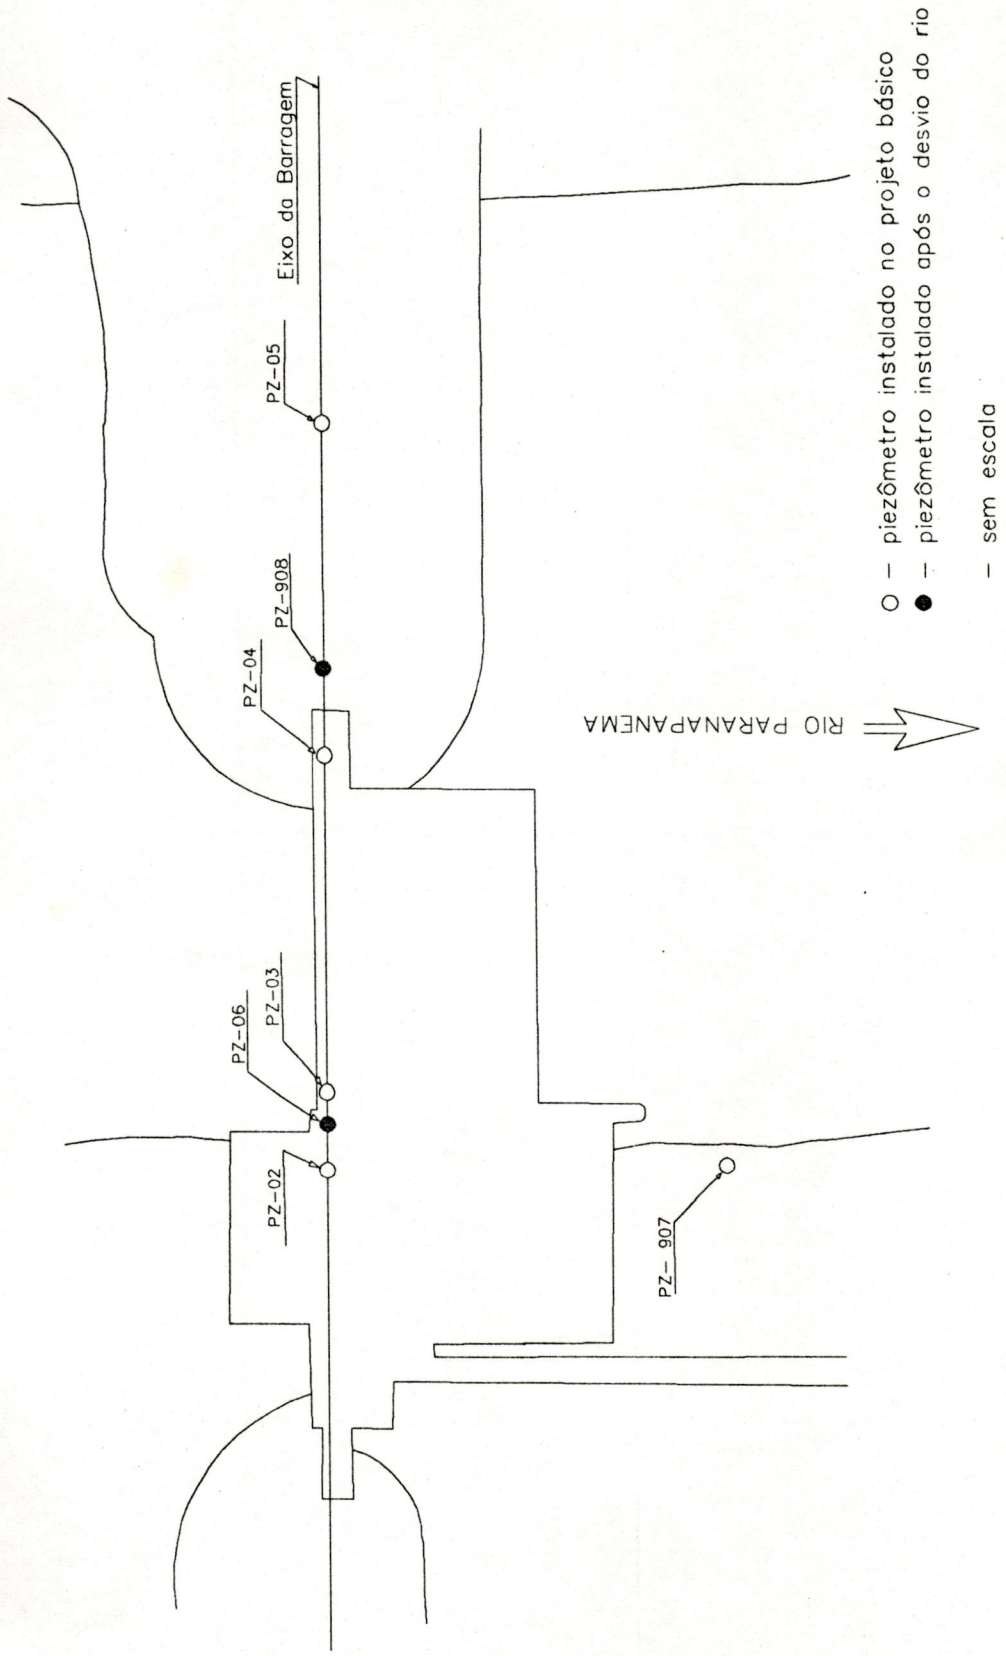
Planta de localização dos piezômetros no contato A/B
